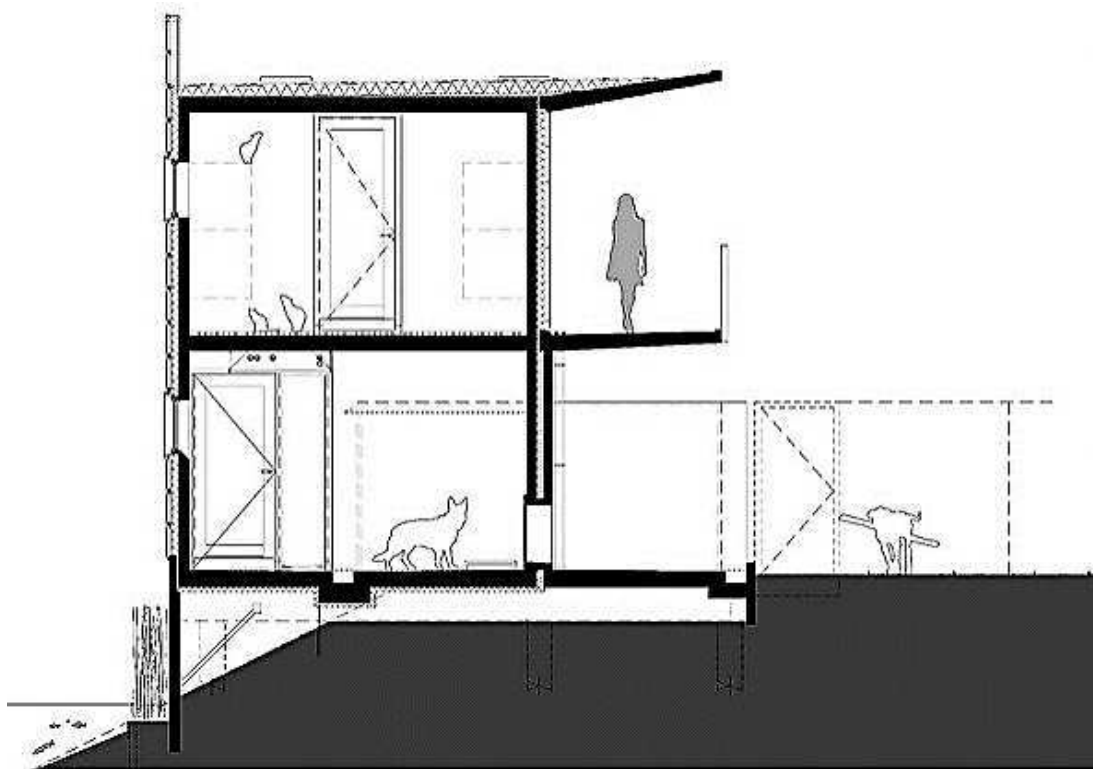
Sección A, al noreste del Centro. Fuente: <https://www.flickr.com/photos/>
